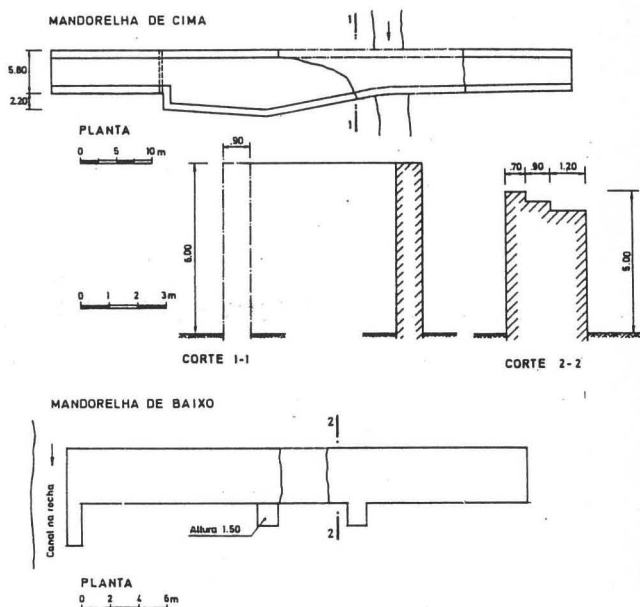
Barragens da Mandorelha de Baixo e de Cima. Esboço de plantas e perfis.
